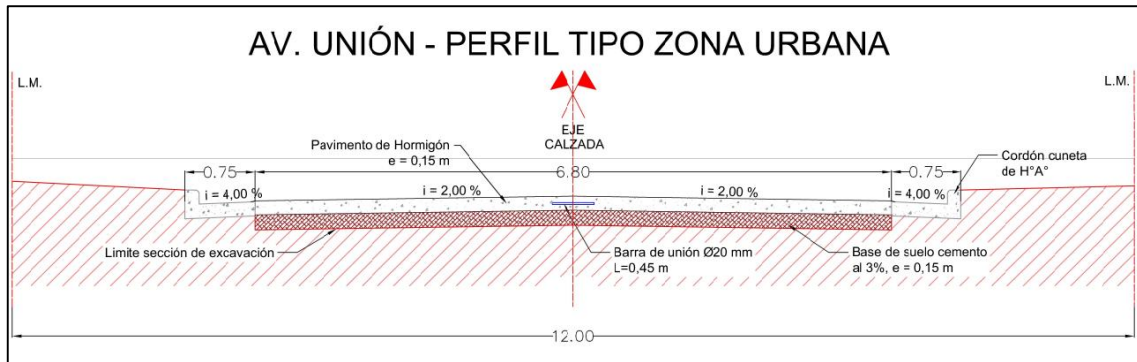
Sección transversal tipo de la Av. Unión en zona urbana
